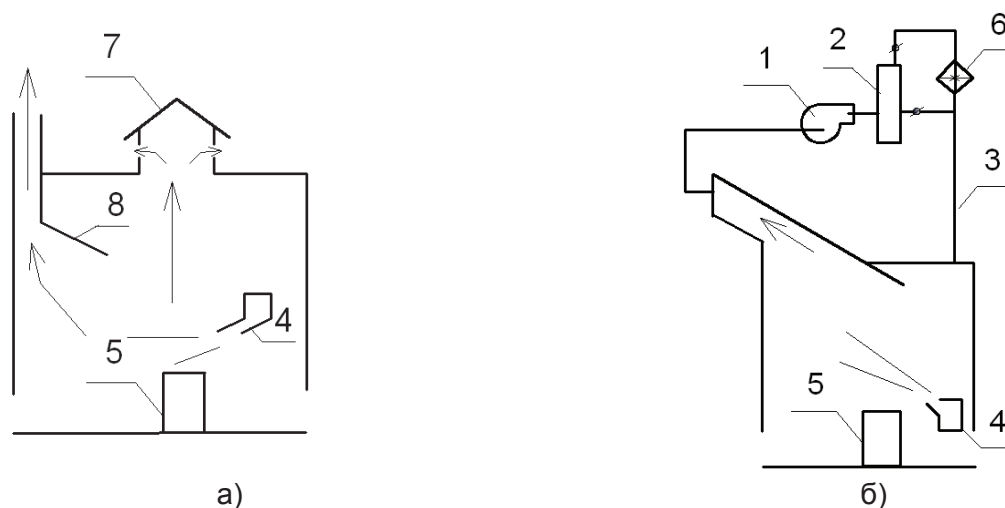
Схемы вентиляции цеха: а) естественная с использованием местного отсоса с передувкой и фонаря; б) со скатной крышей и теплоутилизатором: 1 – вентилятор; 2 – пылегазоочистная установка; 3 – рециркуляционный воздухопровод; 4 – приточный насадок; 5 – источник тепловыделений; 6 – рекуператор теплоты; 7 – аэрационный фонарь; 8 – местный отсос
